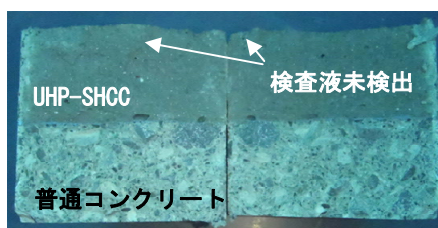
防水性試験Ⅱ結果（コンクリート-UHP）
